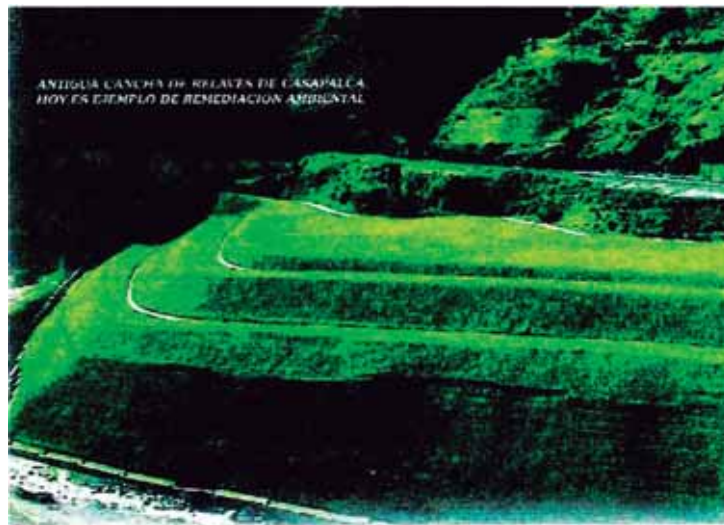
ANTIGUA CANCHA DE RELAVES- CASAPALCA
